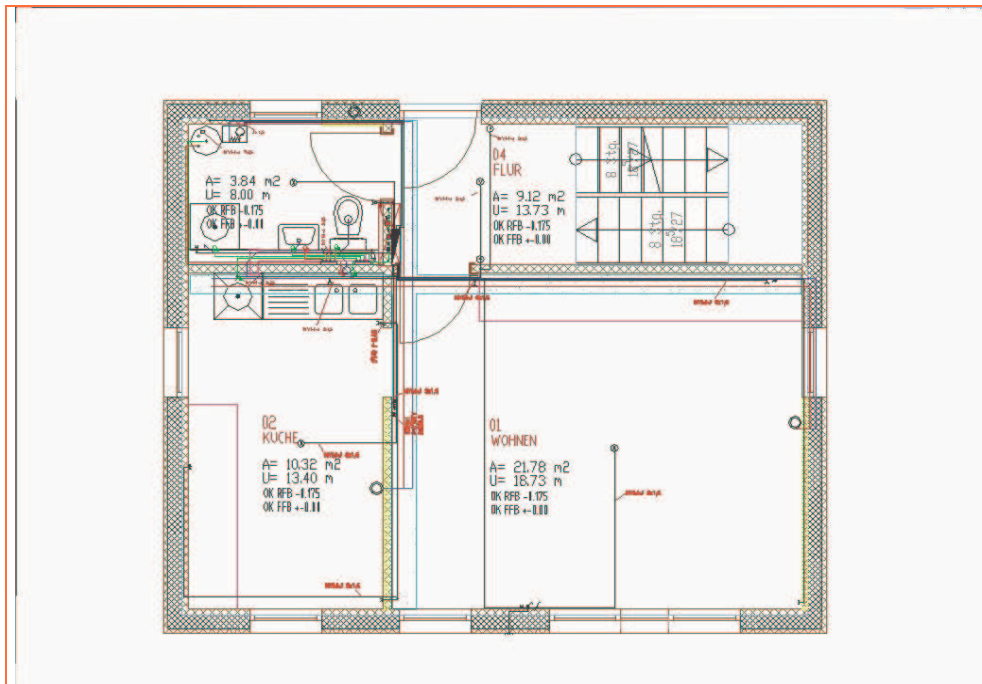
Mustergebäude, Grundriss EG
